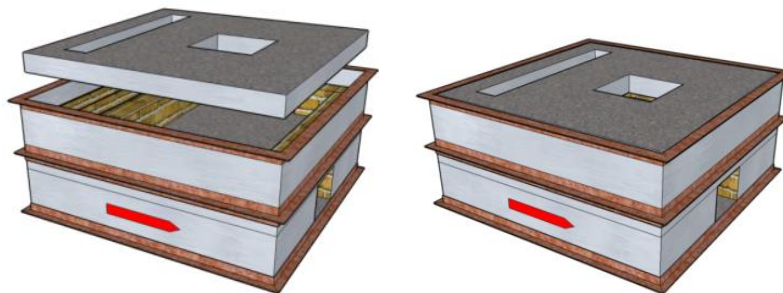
Módulo 2 ou cinzeiro, recebendo a laje e pronto para receber o módulo 3 ou câmara de combustão primária.
